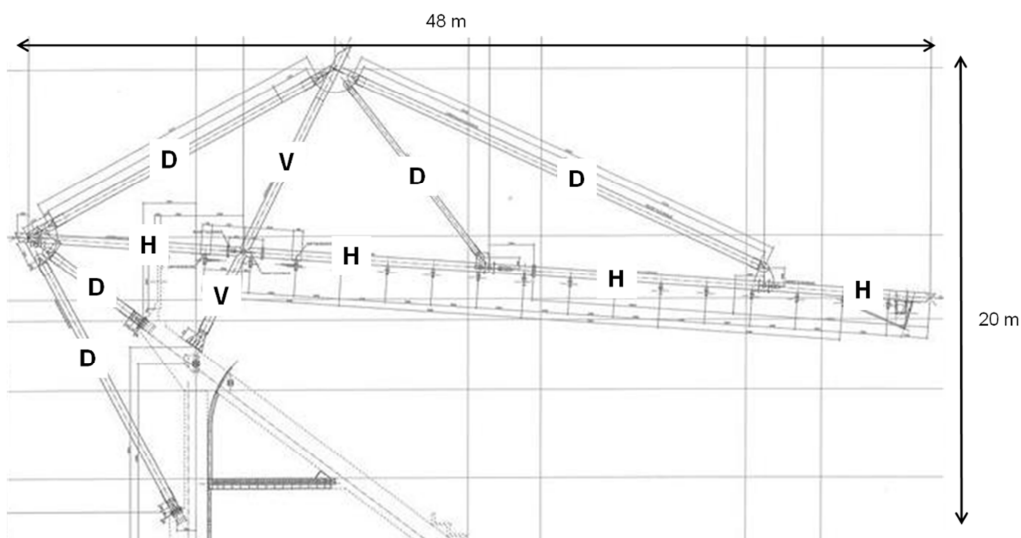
Situering van de onderdelen van de hoofddraagconstructie in het bovenaanzicht van de overkapping [T.07];
